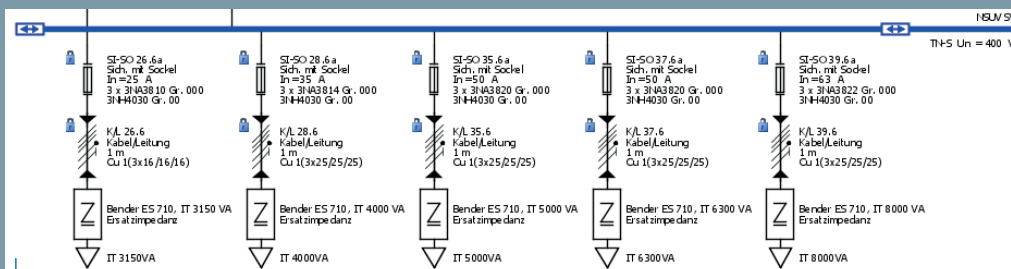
Secciones de cables y fusibles de respaldo para los transformadores de aislamiento de TI
